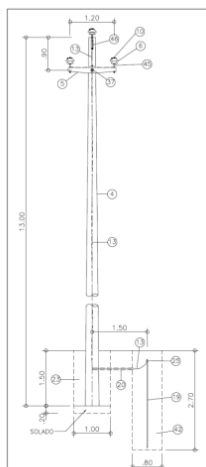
Esquemático postes hormigón armado 10 [kV] – Proyecto
